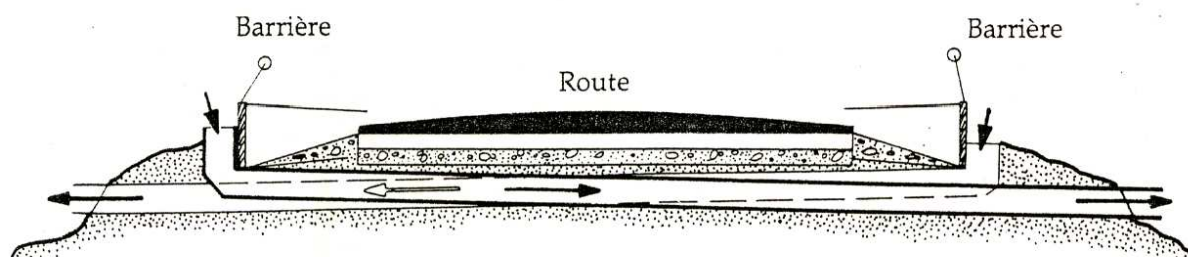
Paire de tunnels à un sens (coupe verticale).
